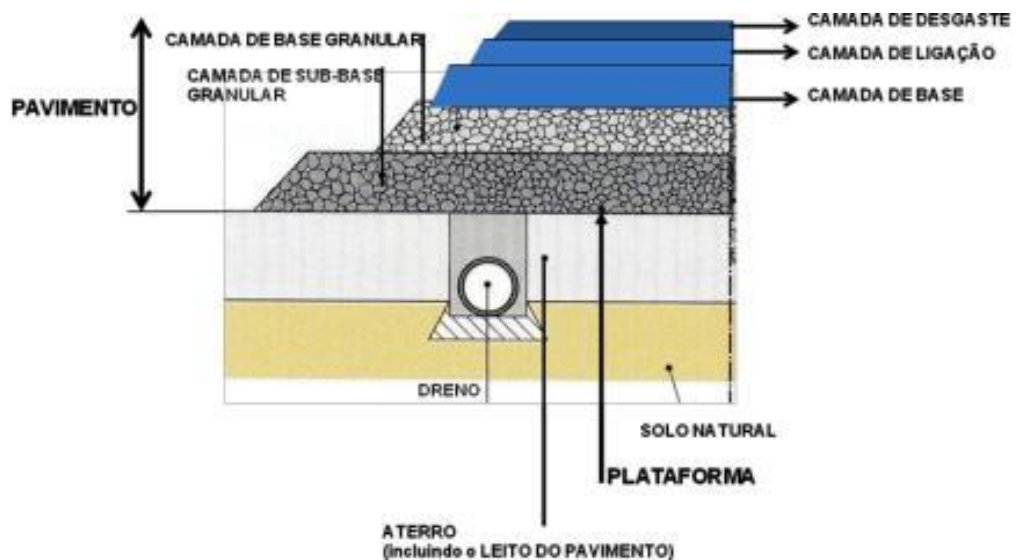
Vista de corte de um pavimento rodoviário (flexível) (Inir,2017)
